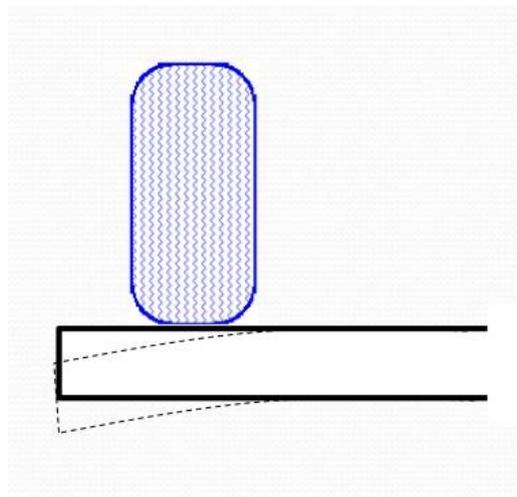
Transferencia de Cargas a un Pav. Rígido
